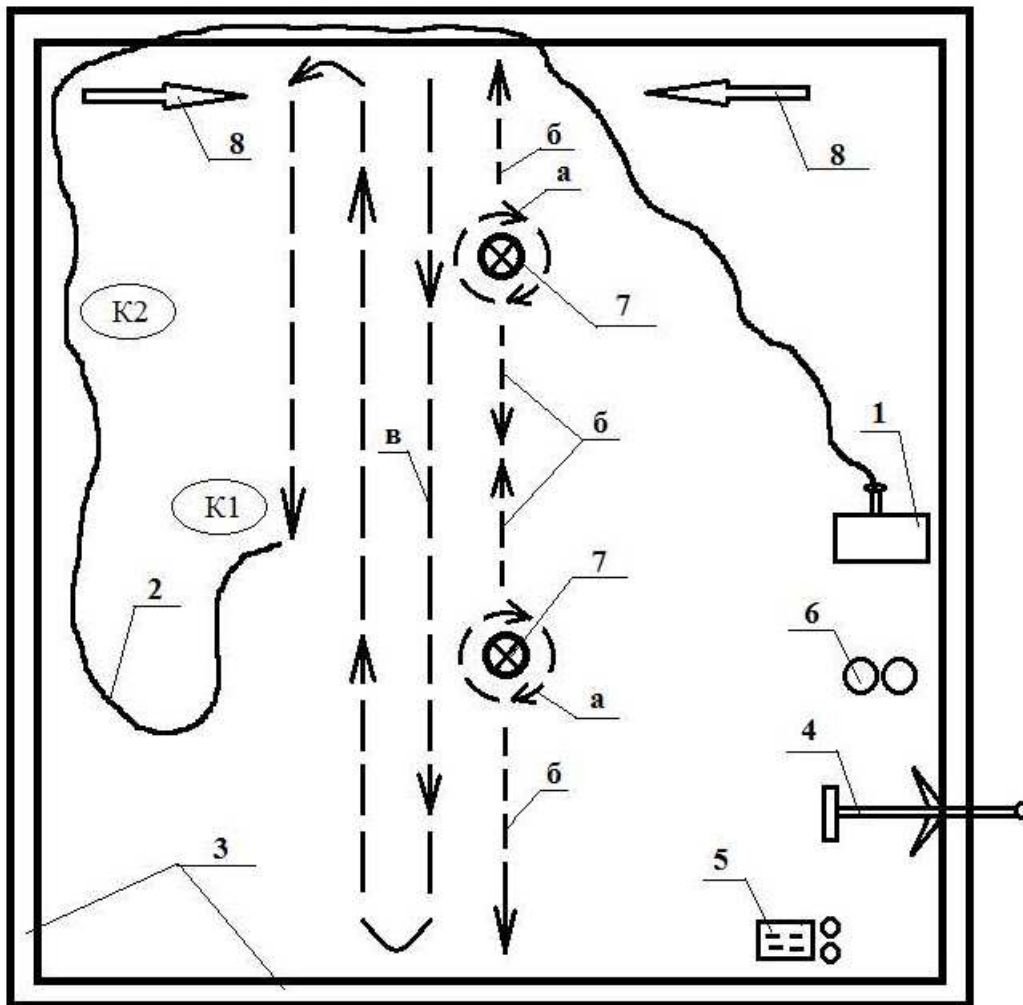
Схема организации рабочего места при устройстве кровли из жидкой резины «CBS кровельная», размещение установки непосредственно на крыше:
